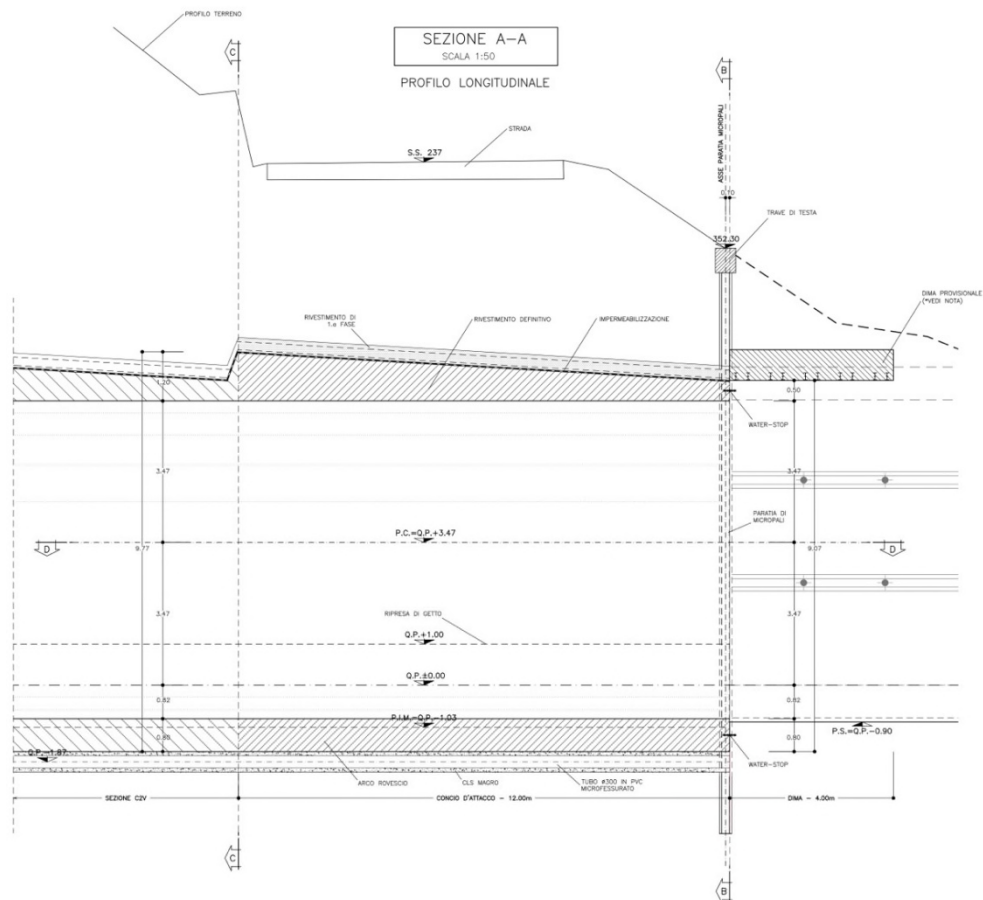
Sezione di Attacco – Carpenteria – Profilo longitudinale
